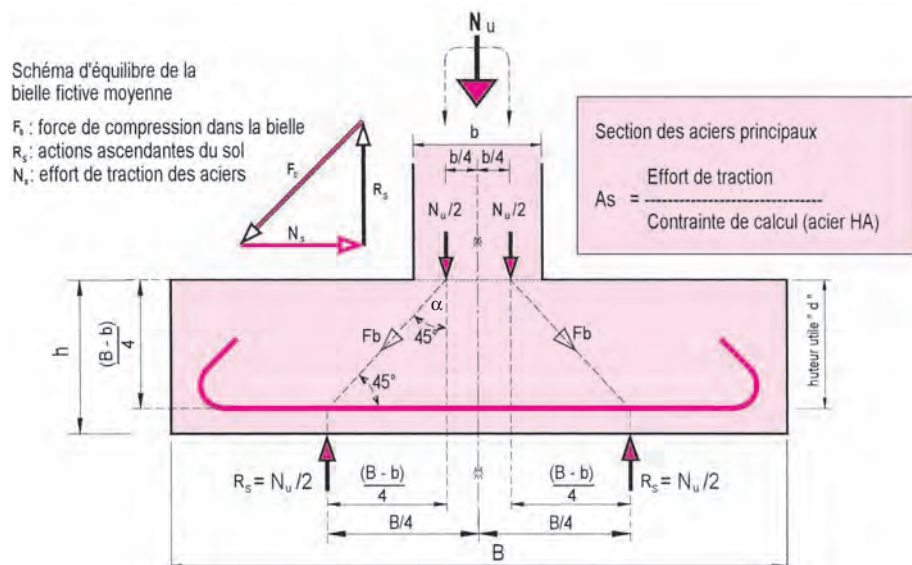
Détermination de la section d'acier d'une semelle isolée
